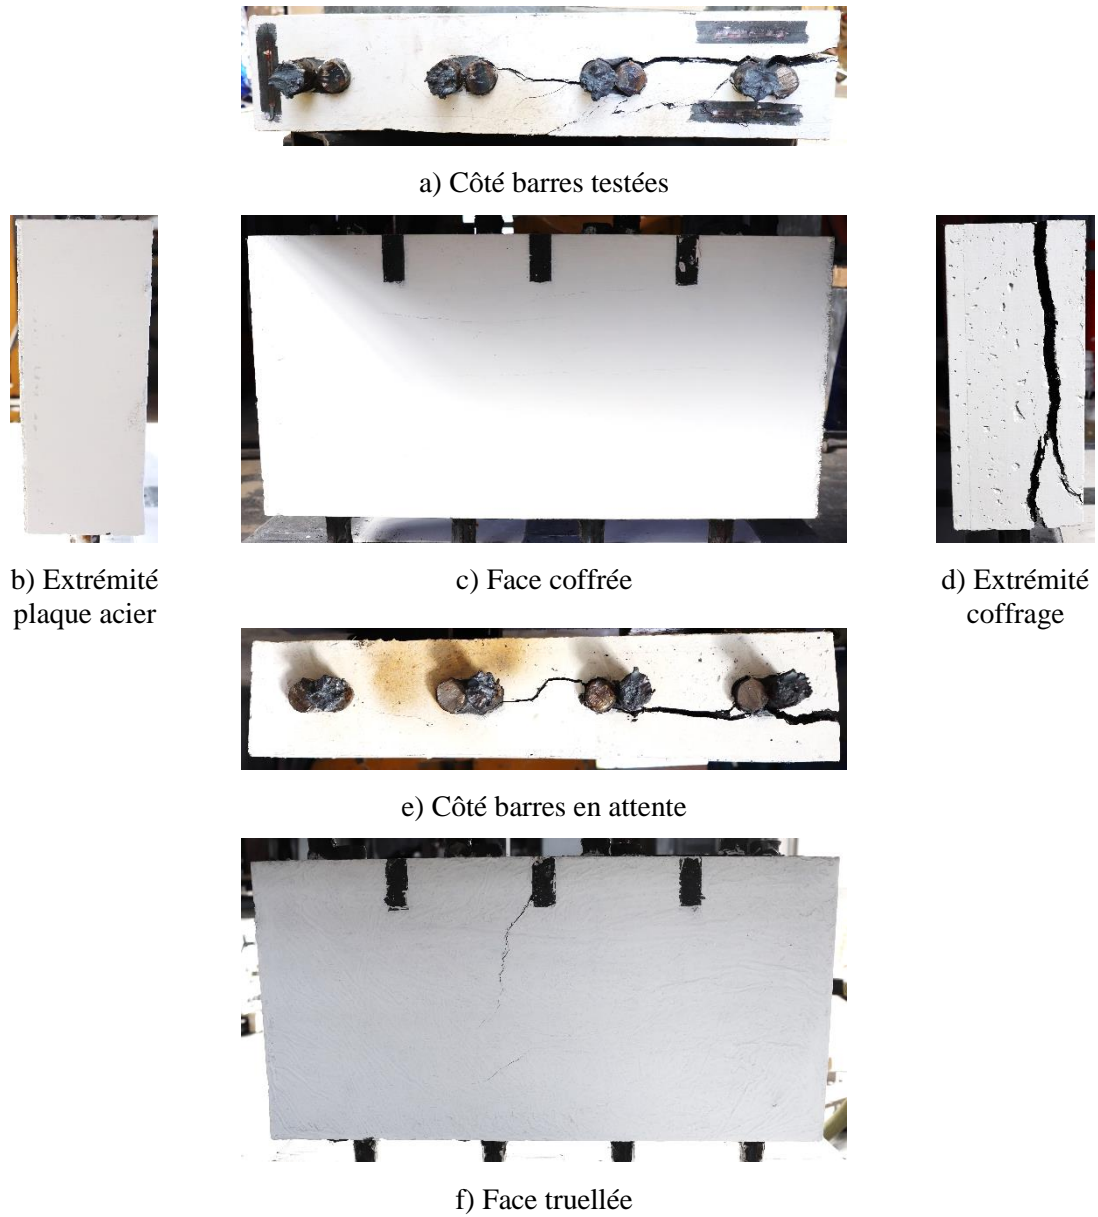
Fissuration observée en laboratoire - Spécimen CL
